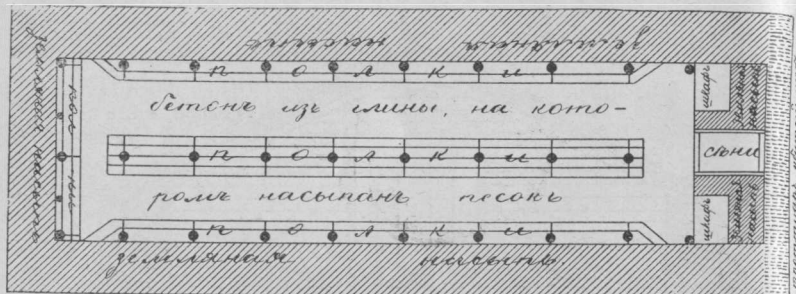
Планъ надземнаго плодохранилища г. Трусова.
